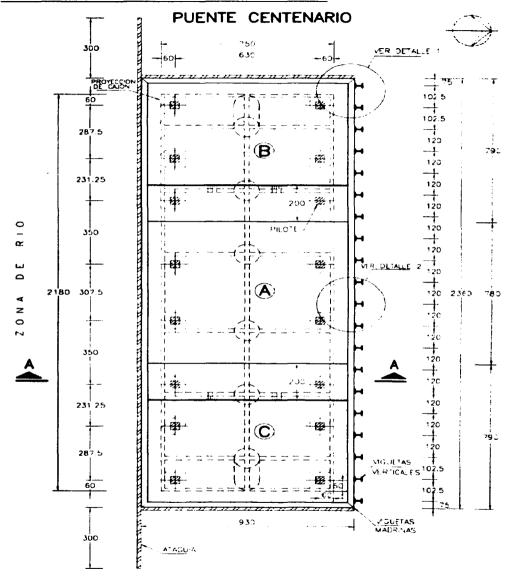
PLANTA DE EXCAVACION DEL CAJON TIPO I ADVACENTE AL RIO
